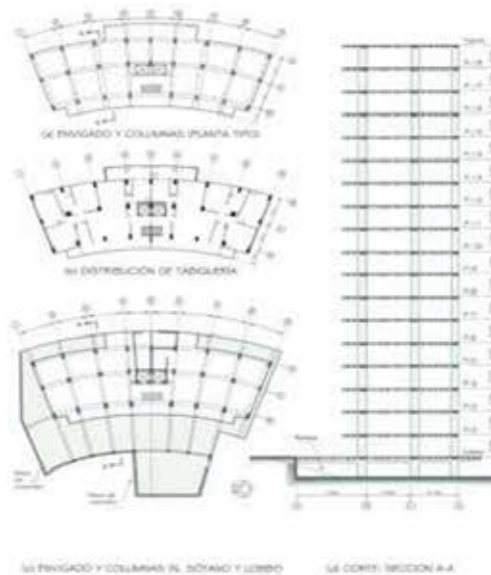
Ubicación de vigas, columnas y distribución de la tabiquería.
